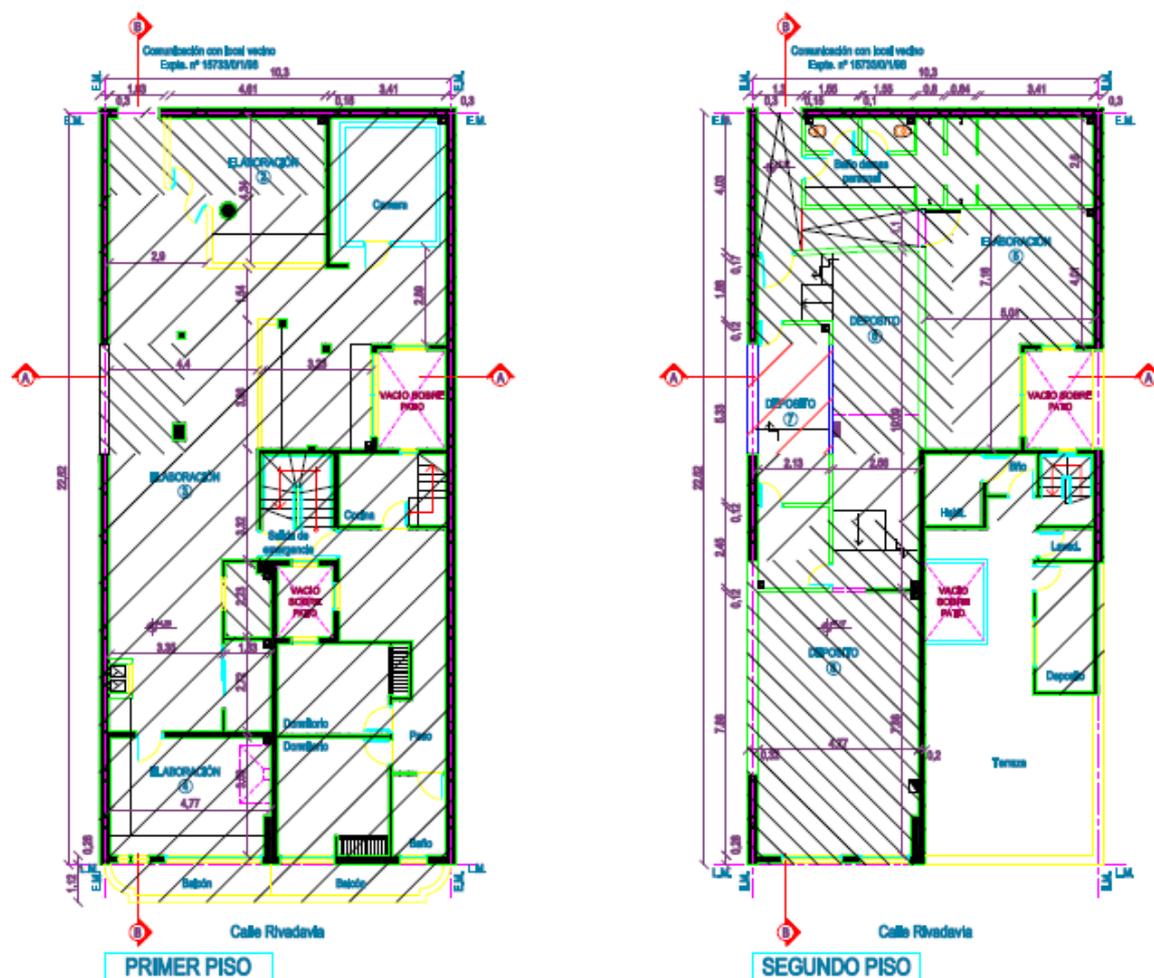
Ilustración II.- Planos de la calle Rivadavia (1er y 2do piso)
